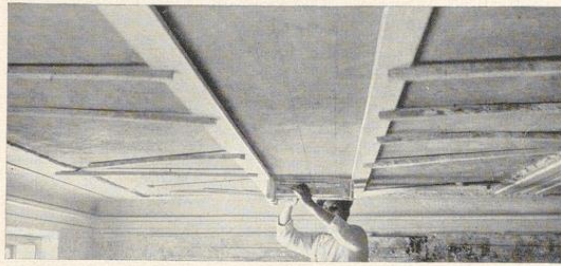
Mit Federn befestigte Latten als Anschlag für den Deckenzug
